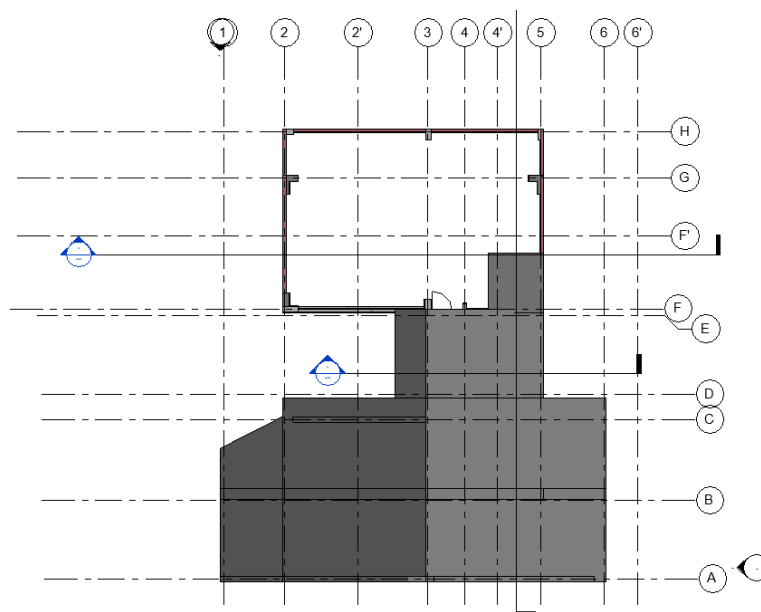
Vista en planta del modelo arquitectura techo y cobertura
